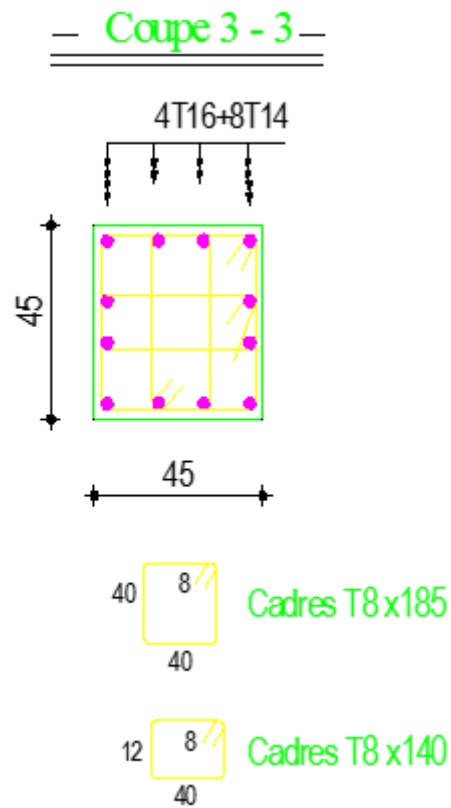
Exemple de ferrailage d'un poteau (45×45)
